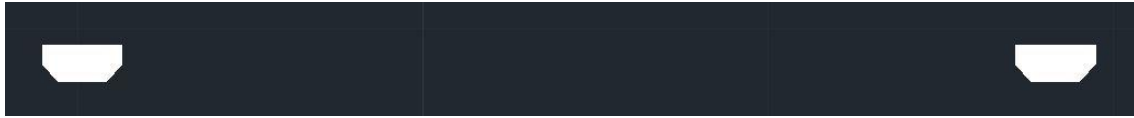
Figura en 2D de la sección transversal de las aceras correspondientes a las partes laterales del puente donde sí están divididas las aceras.
